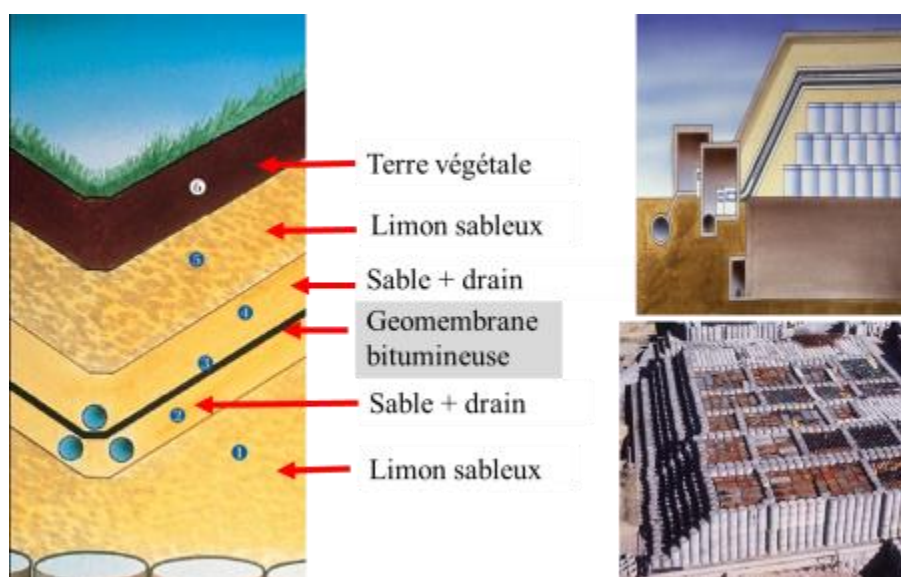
CSM de La Hague : coupe-type de la barrière de couverture et photo du stockage des colis.
